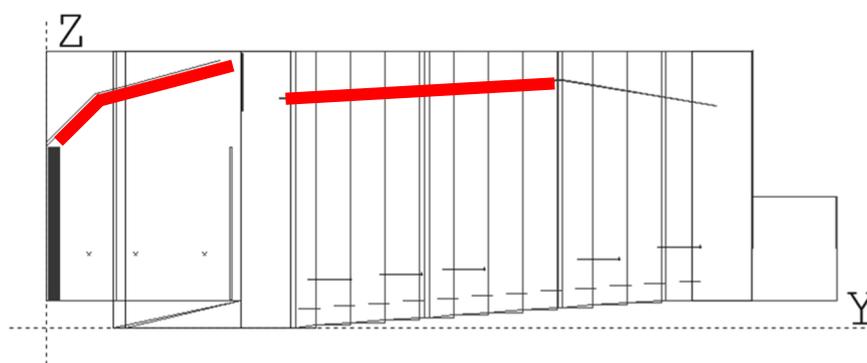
È sezione longitudinale della sala ed elementi riflettori
